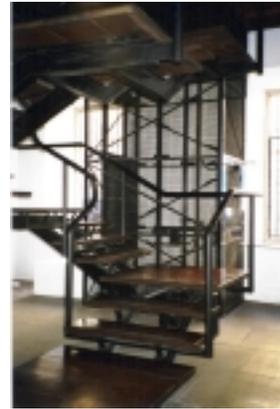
Paço Imperial – Elevador de acesso ao pavimentos superiores, 2006.
